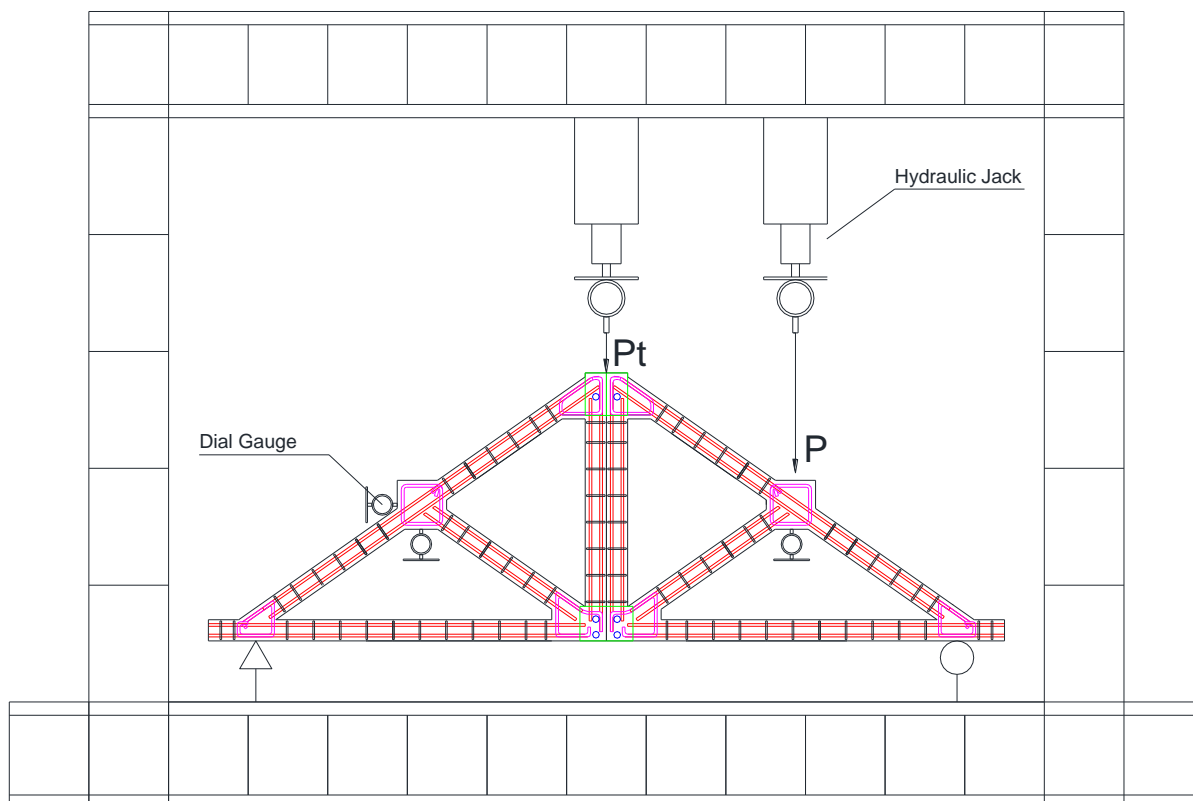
Pemodelan pengujian kuda-kuda sambungan grouting vertikal simetris
